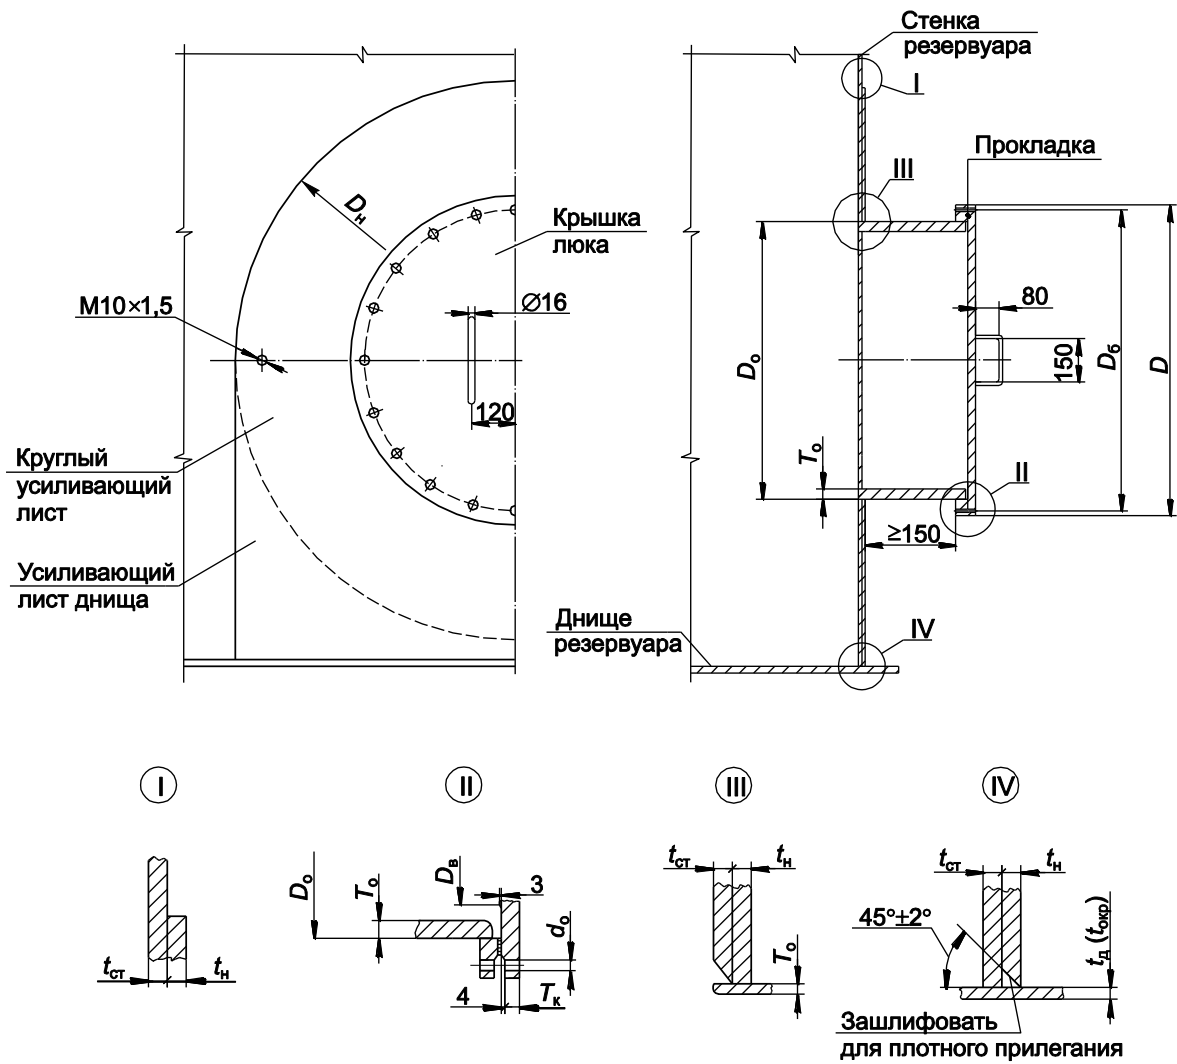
Круглый люк-лаз в первом поясе стенки
